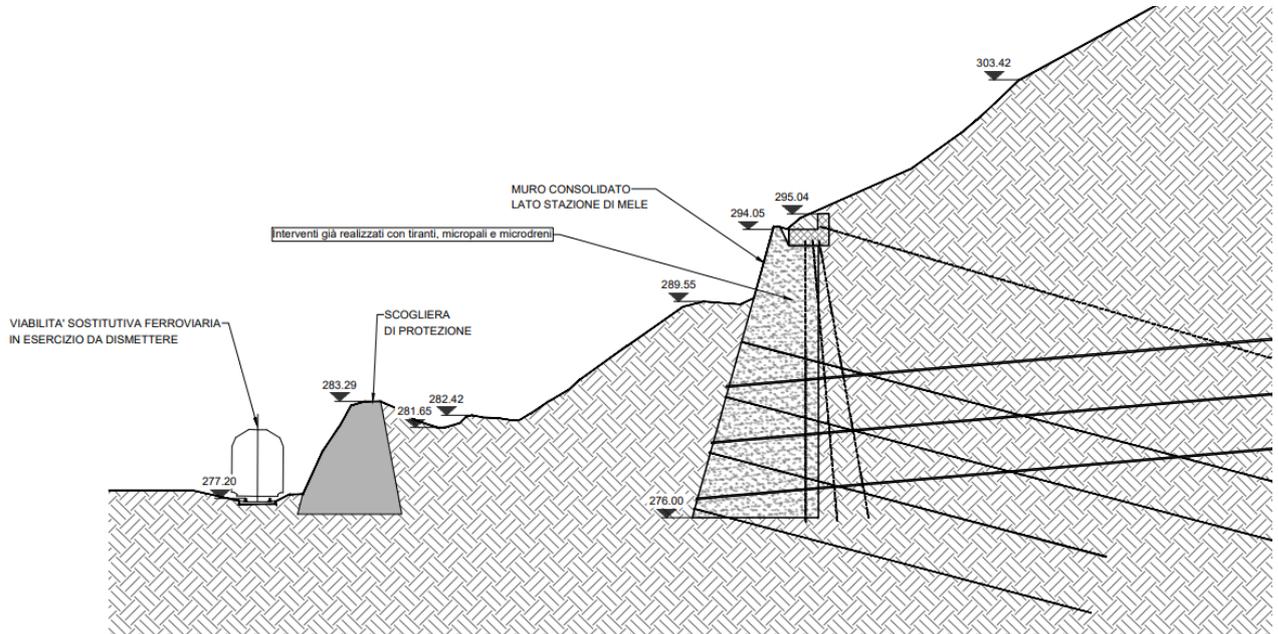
Situazione ante operam – Sezione BB (vedere elaborati di progetto allegati)
